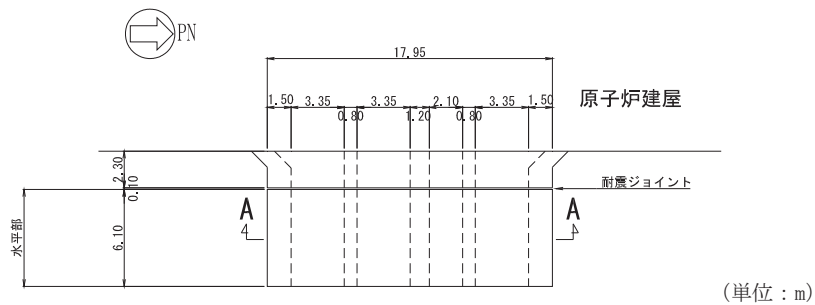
原子炉機器冷却海水配管ダクト（水平部）平面図
